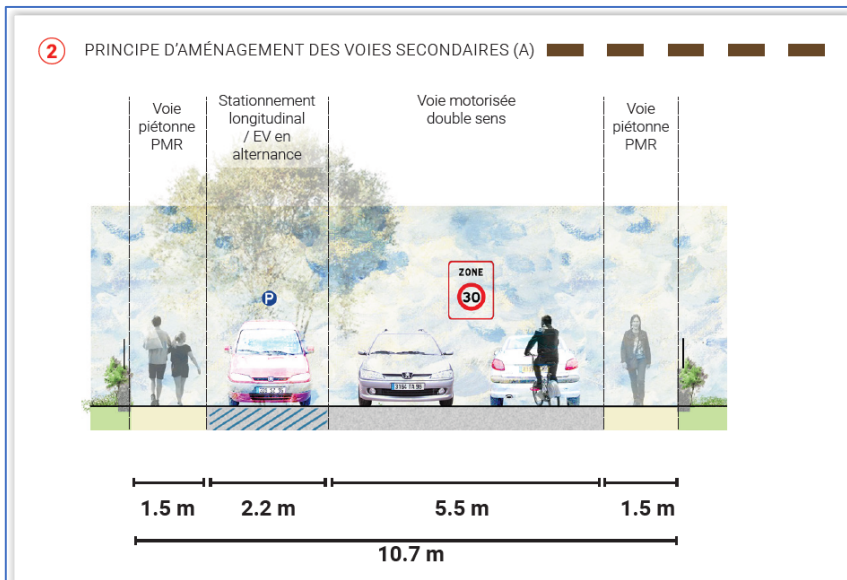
| Voies secondaires, type A et type B : profil en travers de principe
